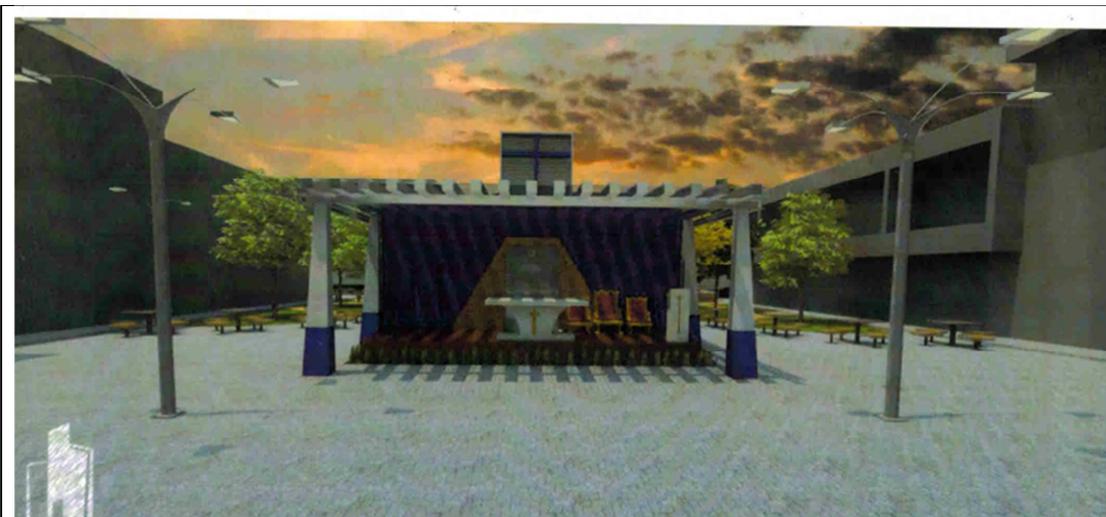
Proposta para fachada posterior da Igreja, com deck, palco e pérgola.
